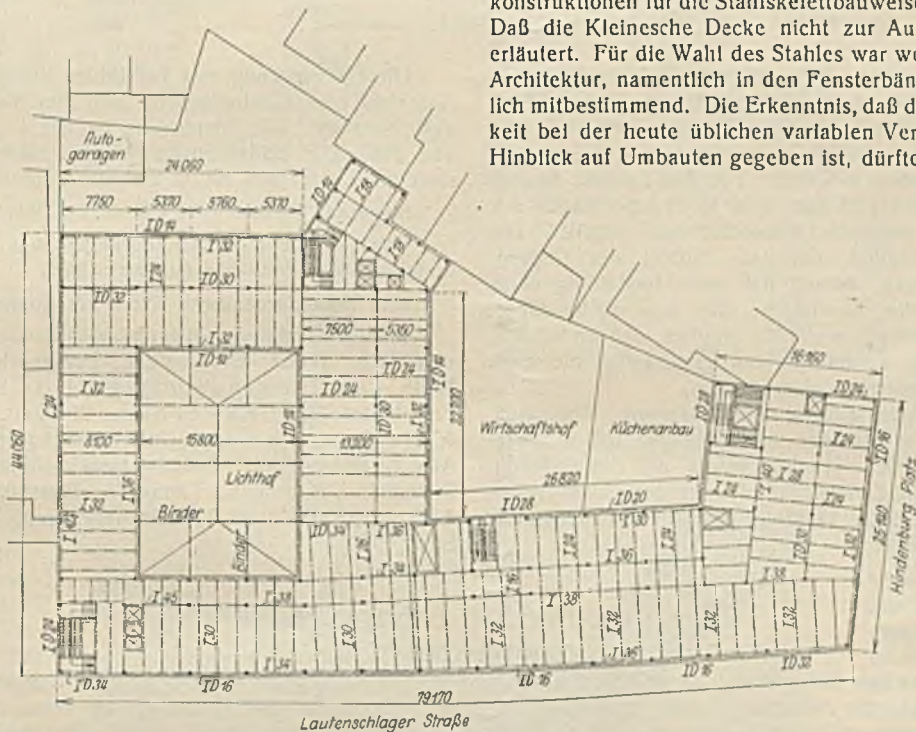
Grundriß und Trägerlagen im Erdgeschoß.
